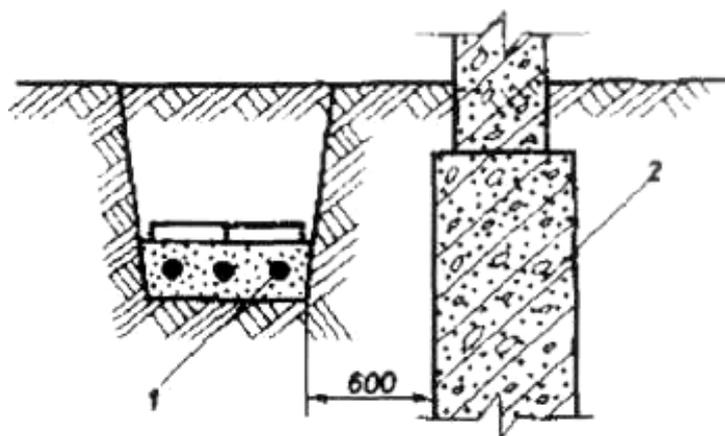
Прокладка кабелей рядом с фундаментом здания и сооружений: 1 – кабель 1...10 кВ; 2 – фундамент
